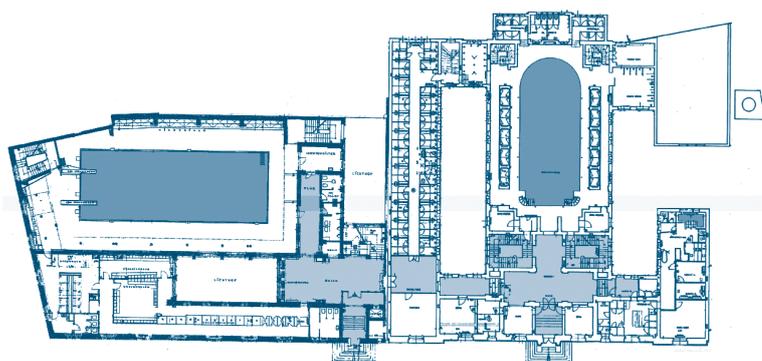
Grundriss des Baerwaldbades, Quelle: Zukunftsbau GmbH
